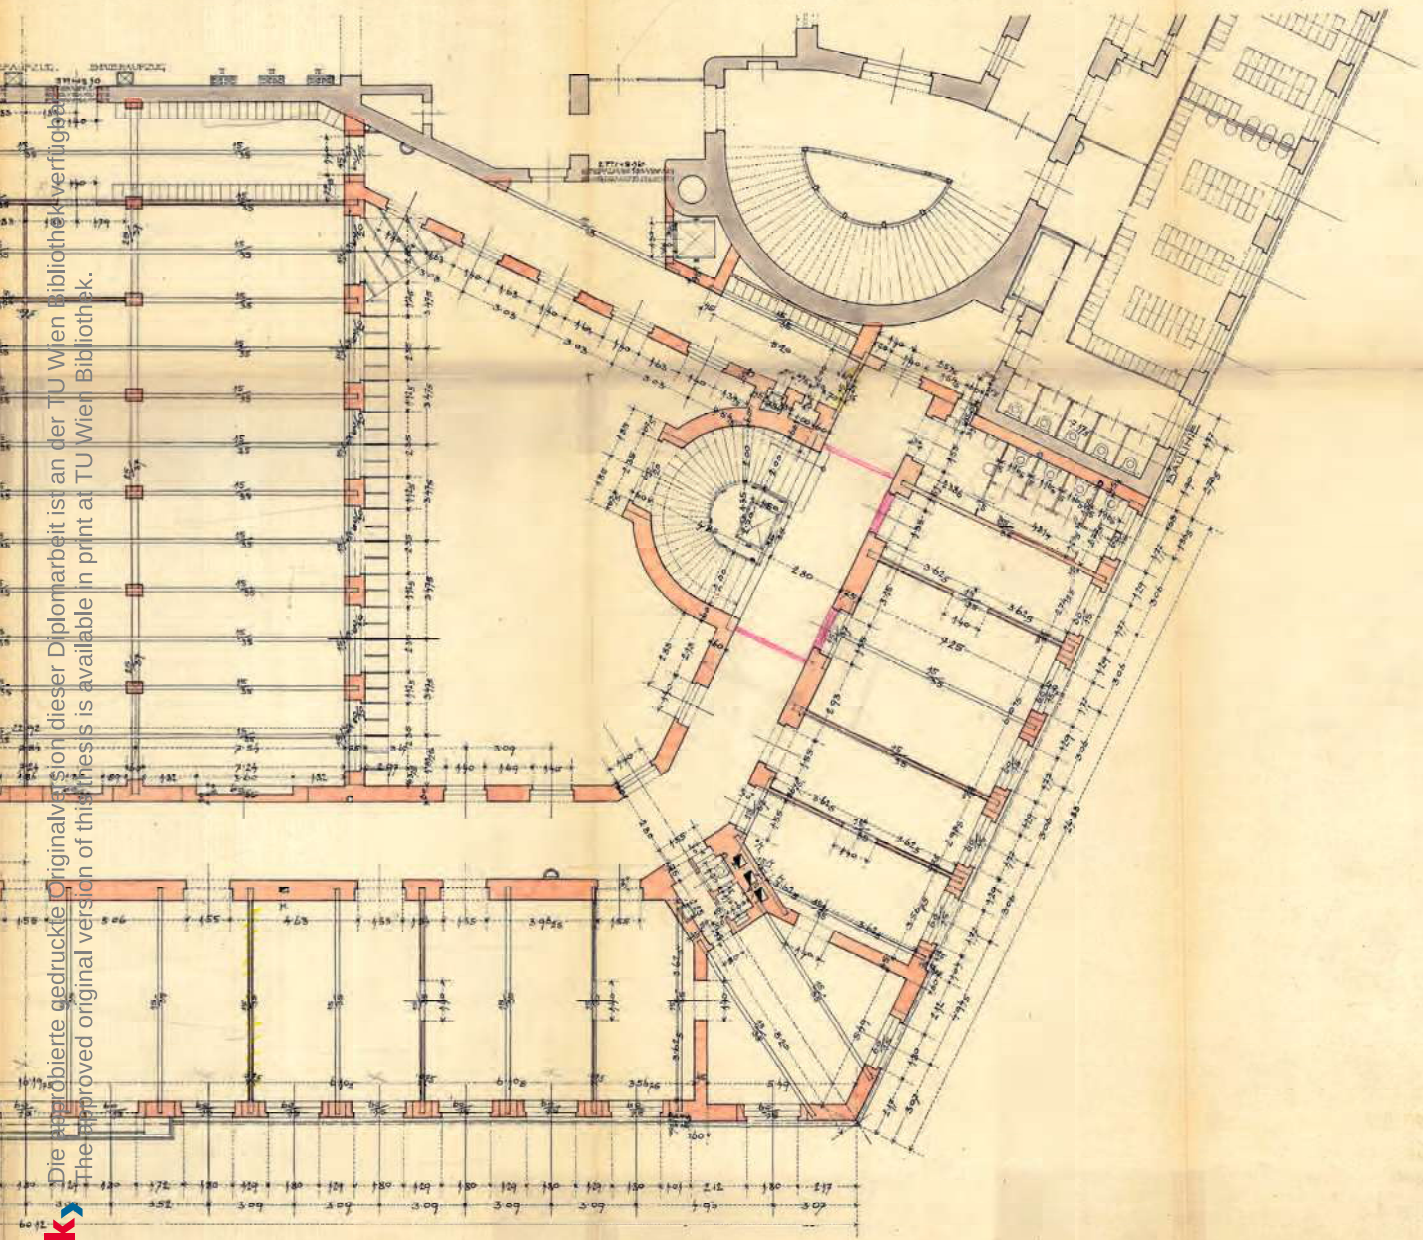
Grundriss Bauteil 2 - 1. Obergeschoß (1910)
